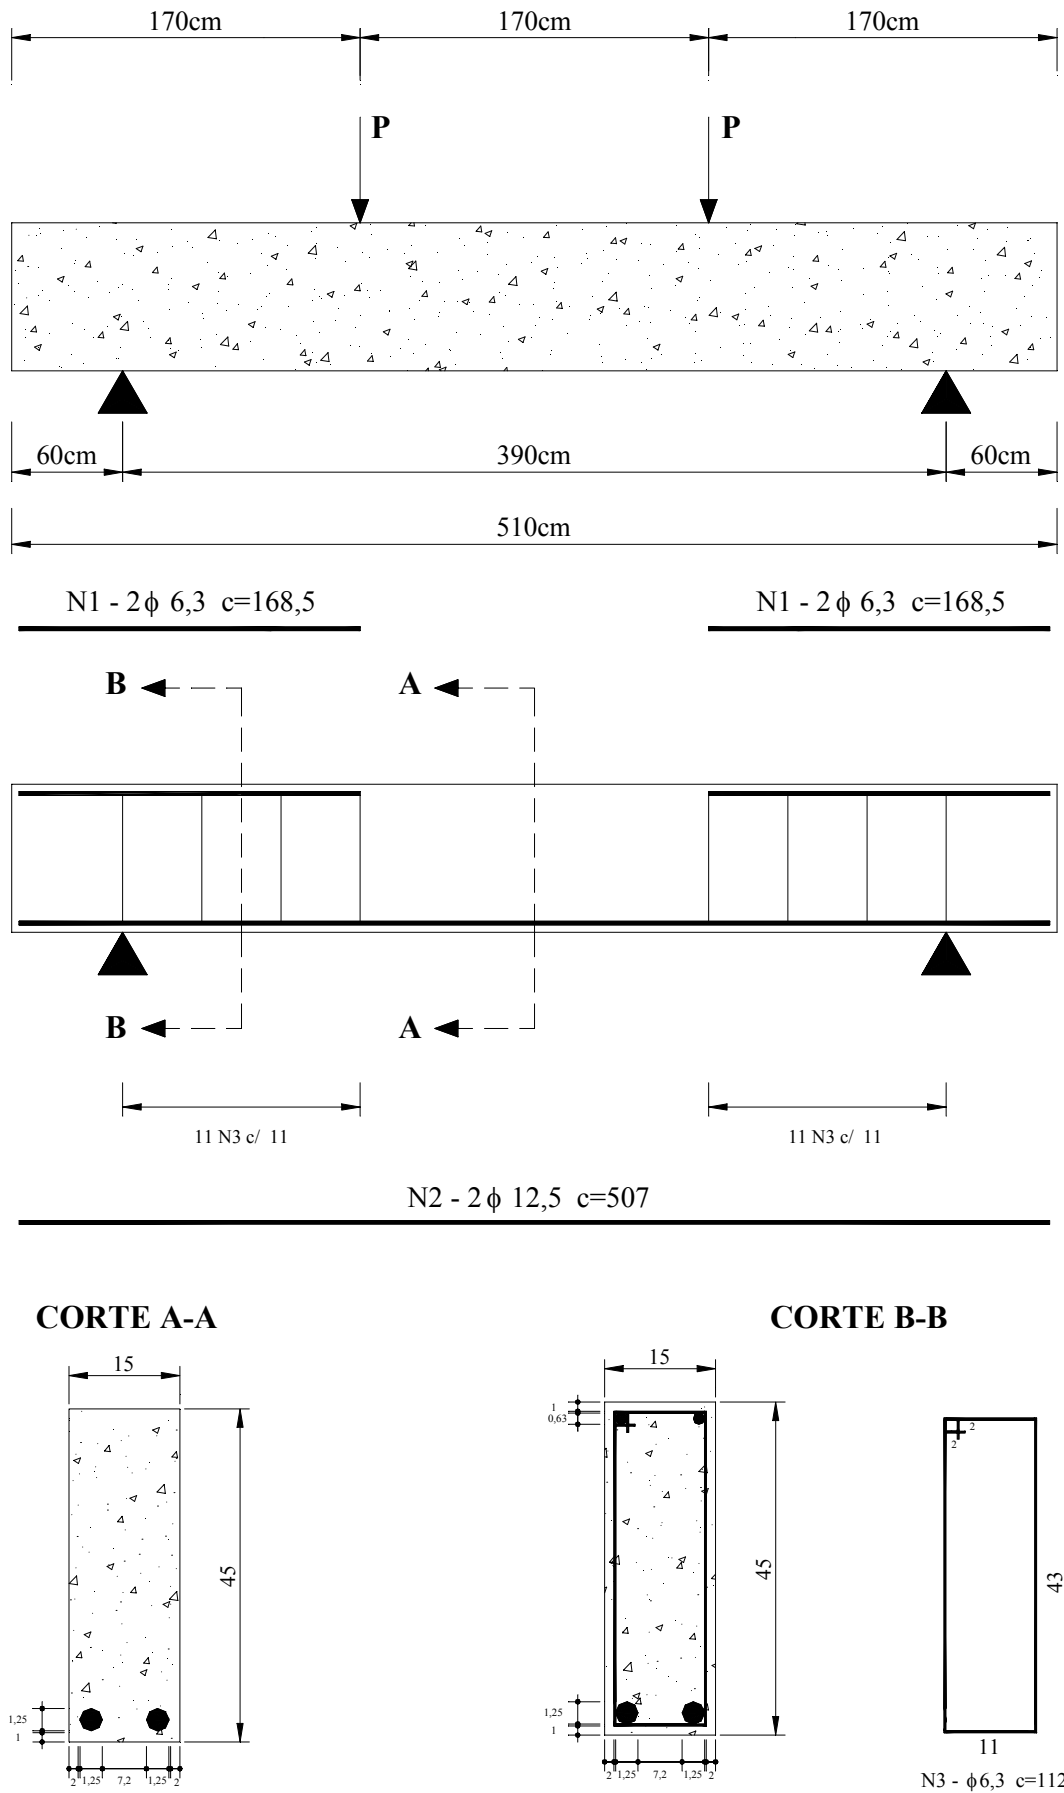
Detalhamento da viga de concreto armado utilizada nas simulações
